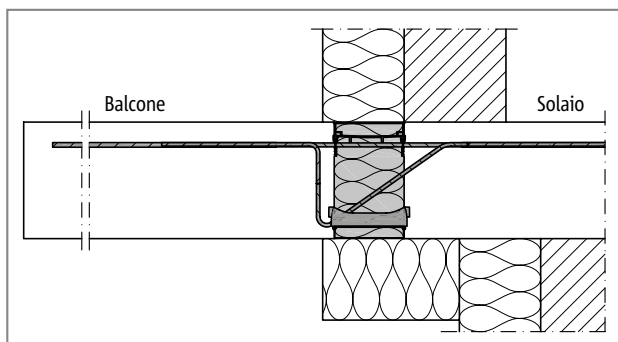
Schöck Isokorb® tipo KXT: raccordo indiretto al solaio e cappotto
